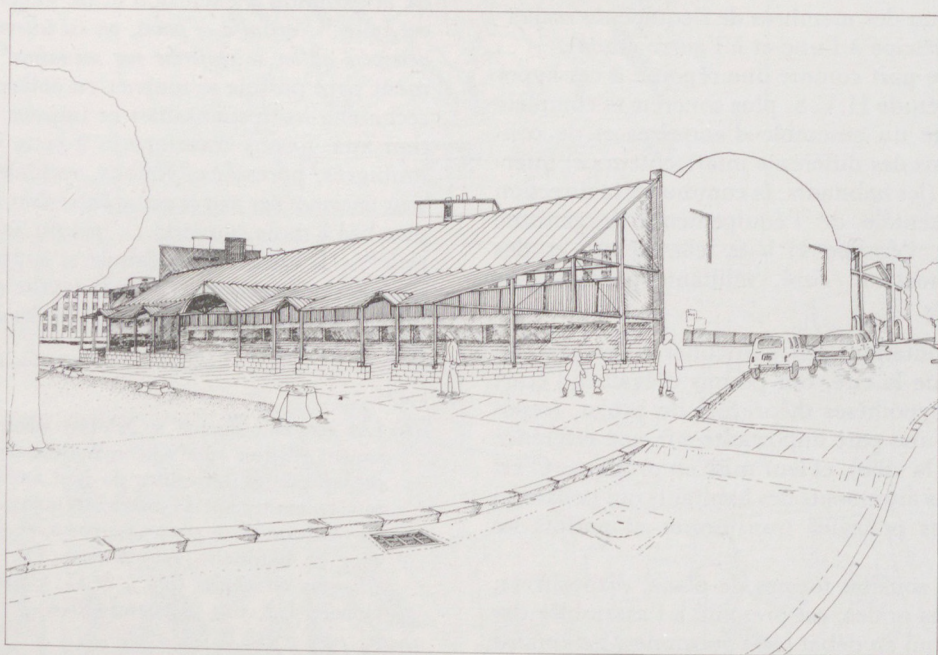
et 35 : aménagement de la dalle de parking, préau, fronton, porte de la cité.
